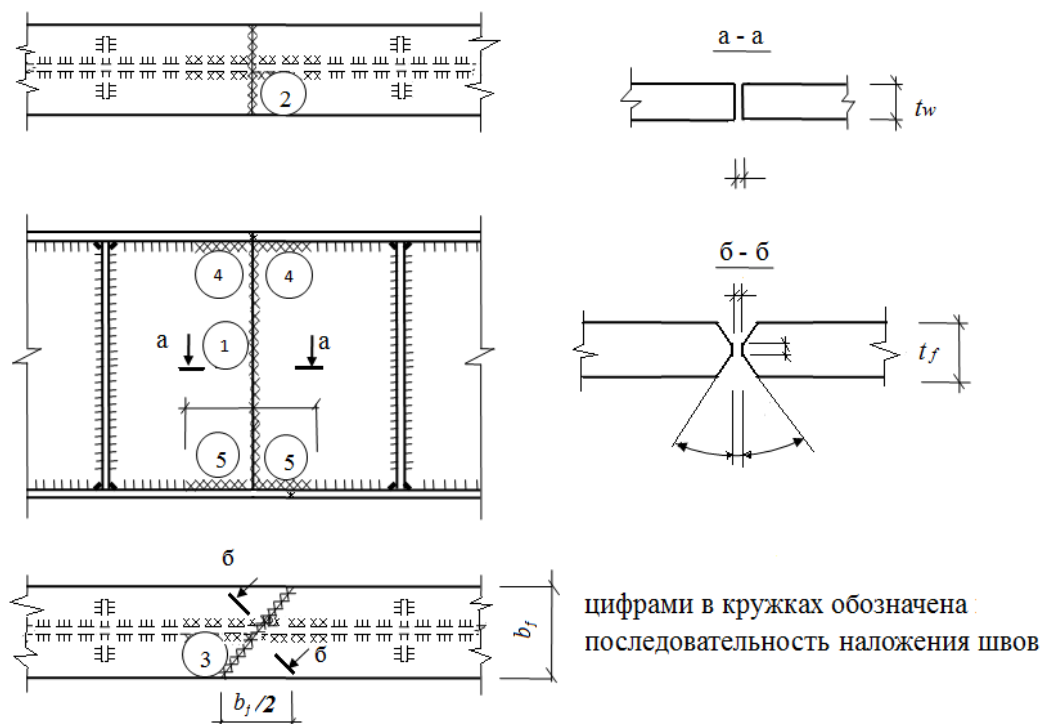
Монтажный сварной стык главной балки
